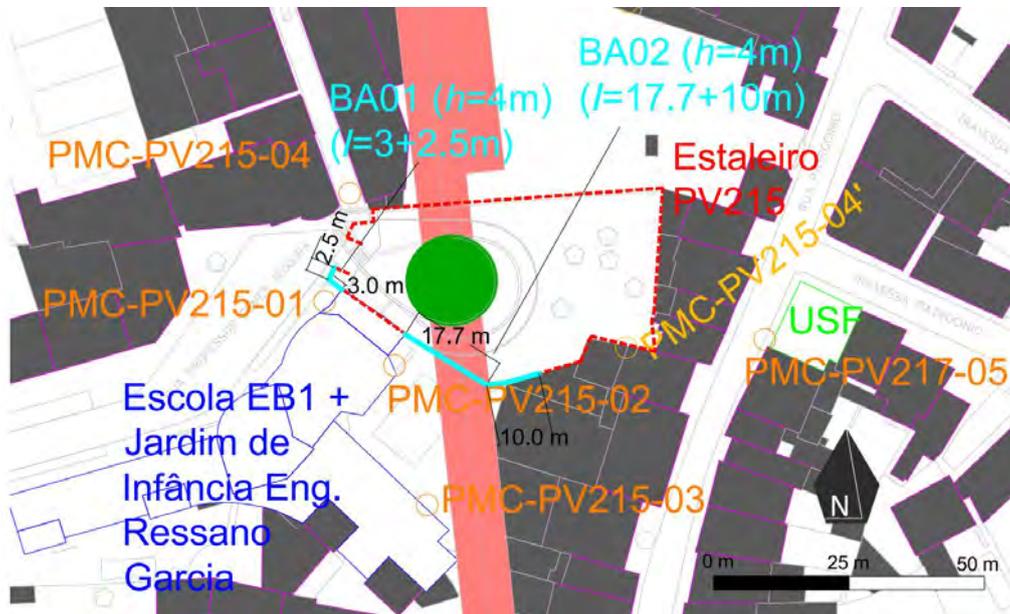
Localização em planta das Barreiras Acústica BA01 e BA02 para proteção da Escola Ressano Garcia
